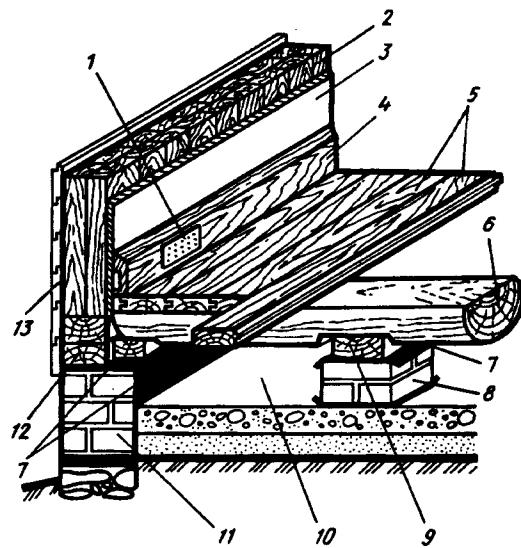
Цокольные перекрытия при кирпичном цоколе и деревянных наружных стенах из досок
